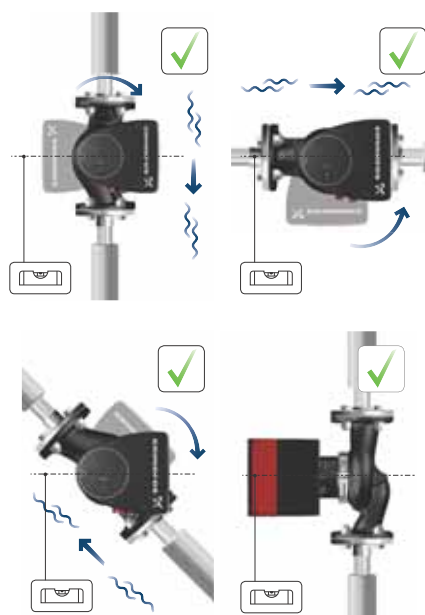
Čerpadlo instalované s horizontálním hřídelem motoru
